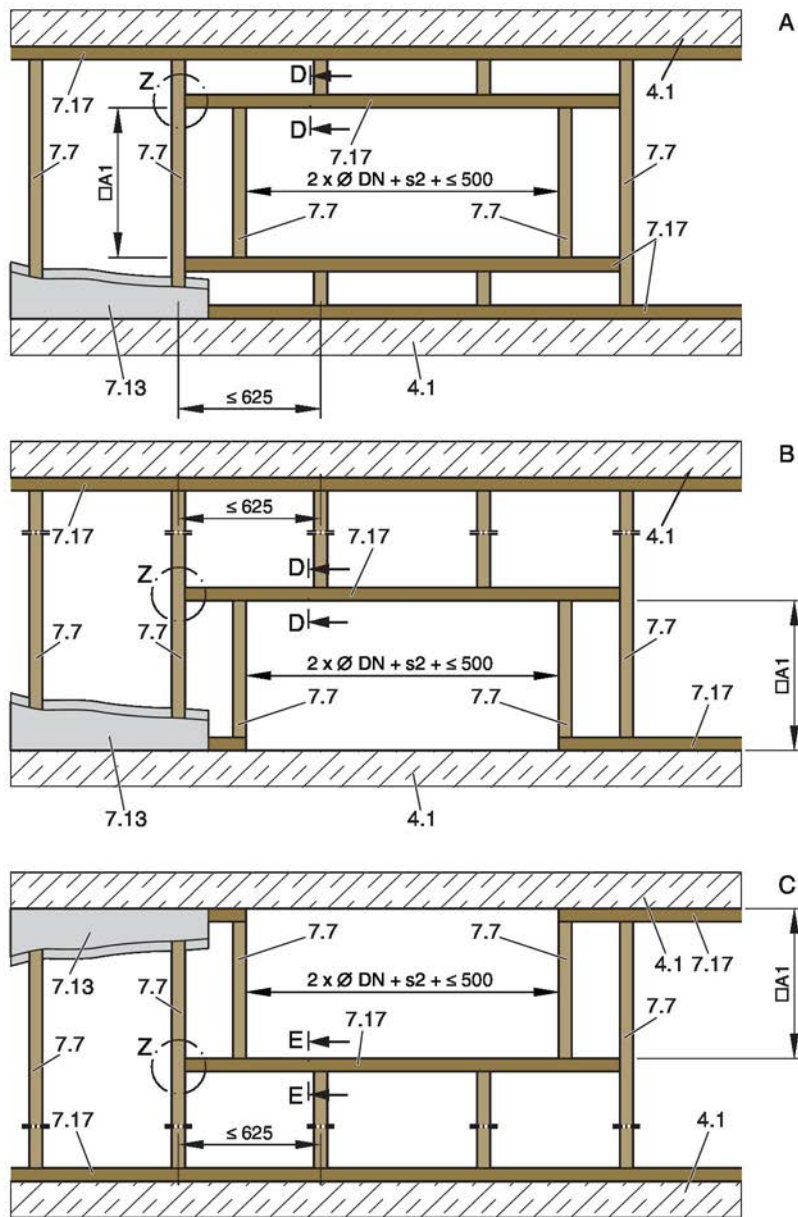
Leichtbauwand mit Holzständer und beidseitiger Beplankung, Flansch an Flansch, Nenngrößen  $\text{Ø DN } 315 - 400$ , Bildlegende Abb. 51
